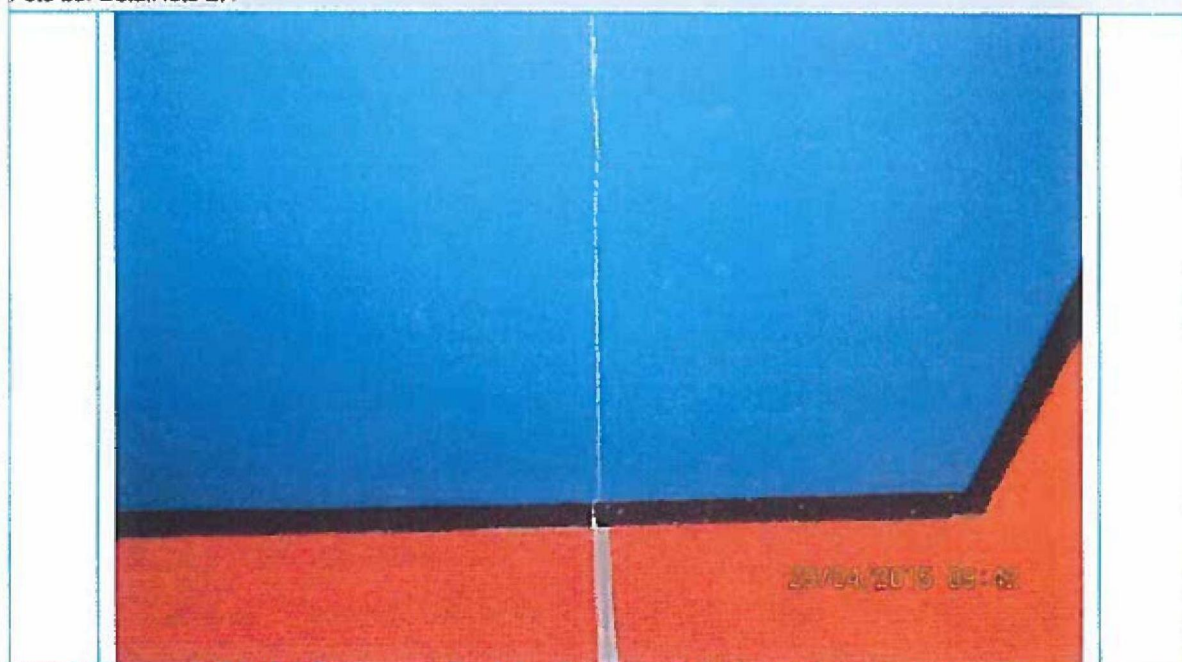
1^o verdieping. (kantoor 1.04) Scheurvorming in aanhechting bouwelementen, wand en plafond. Geen gerelateerde bevestigingschade.
